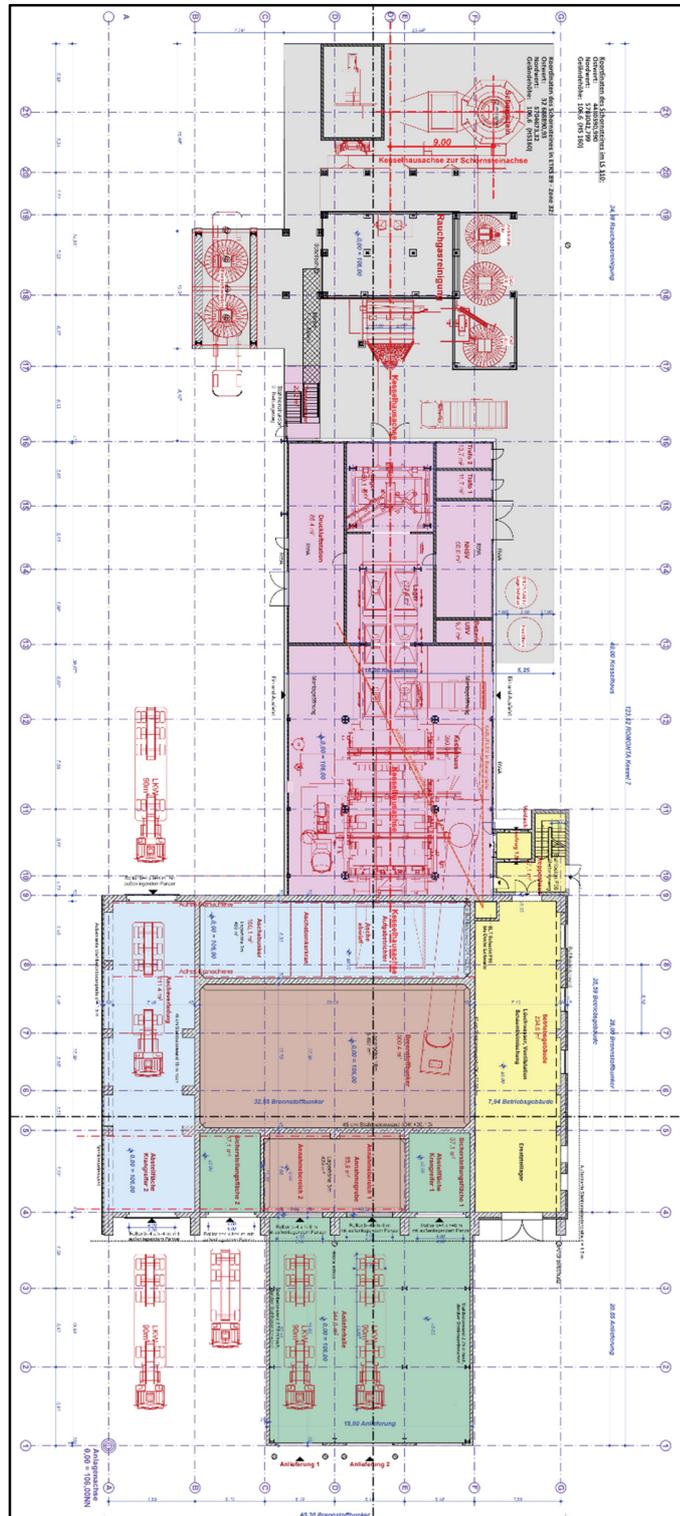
Grundriss DE 7, Entwurfsplanung, Stand 03.05.2021
